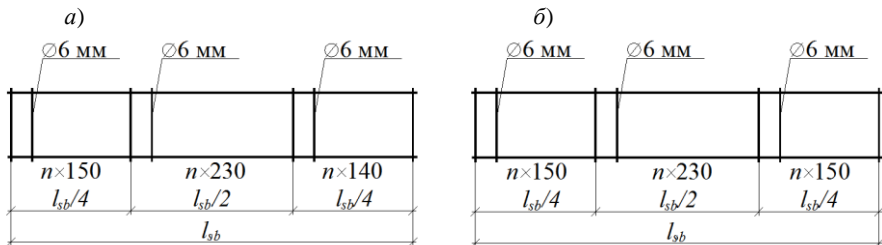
Поперечное армирование второстепенной балки:
